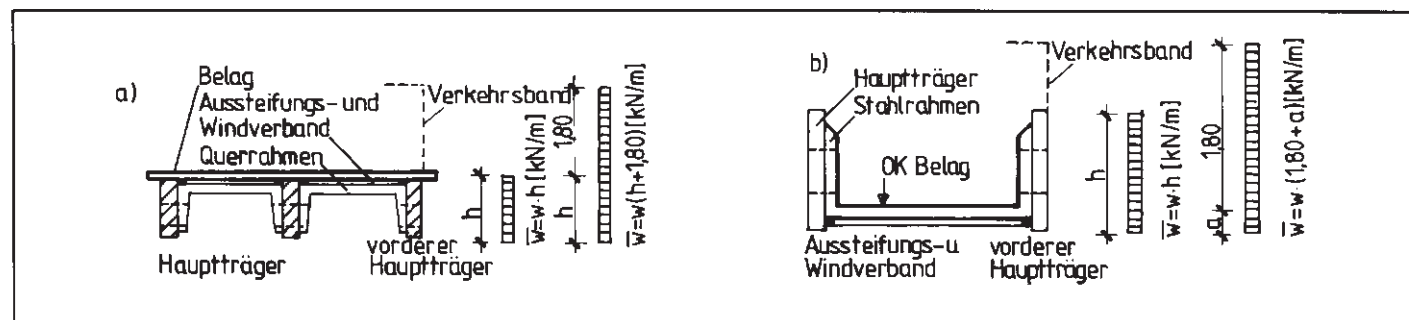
Windangriffsflächen und Windlasten für Geh- und Radwegbrücken
